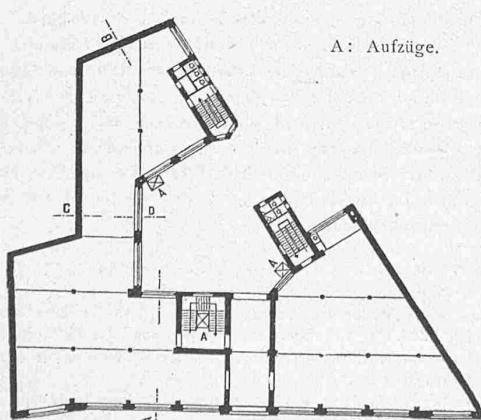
Erdgeschoss-Grundriss 1:800.
